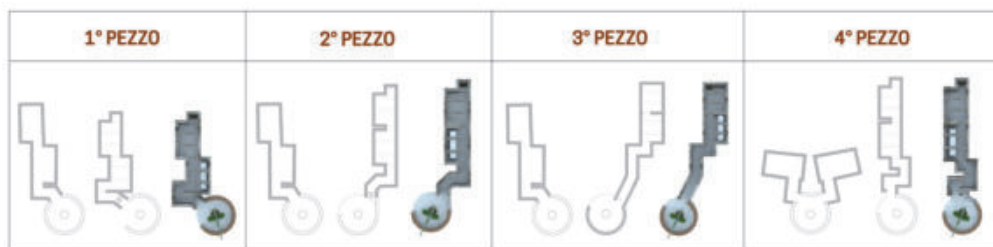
Ricostruzione in pianta (rispettivamente pianta di progetto, pianta rilevata e ricostruzione virtuale) dei pezzi della batteria di Capo Poro. La conformazione risponde ai dettami dell'architettura militare: nella piazzola è posizionato il pezzo di artiglieria, reso mimetico ad uno sguardo dal mare. La riservetta è composta da: un primo vano che, generalmente inclinato sull'orizzontale, serve a proteggere gli artiglieri, che riforniscono di munizioni il cannone, da eventuali esplosioni sulla piazzola esterna; il secondo vano è composto da sei scomparti differenti (definiti 'cariche'), nei quali erano collocati i proiettili; il terzo vano era un ambiente in cui stazionavano gli artiglieri quando di guardia, sul fondo, una botola collocata nella copertura serviva a fuggire in caso di pericolo o di impossibilità d'uscire dall'entrata principale (elaborazione grafica di Alexandra Fusinetti)
